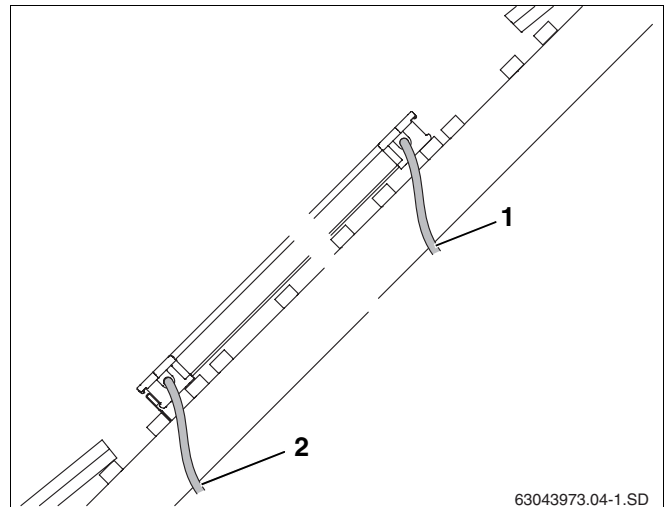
Introducir los tubos de conexión por debajo del tejado
